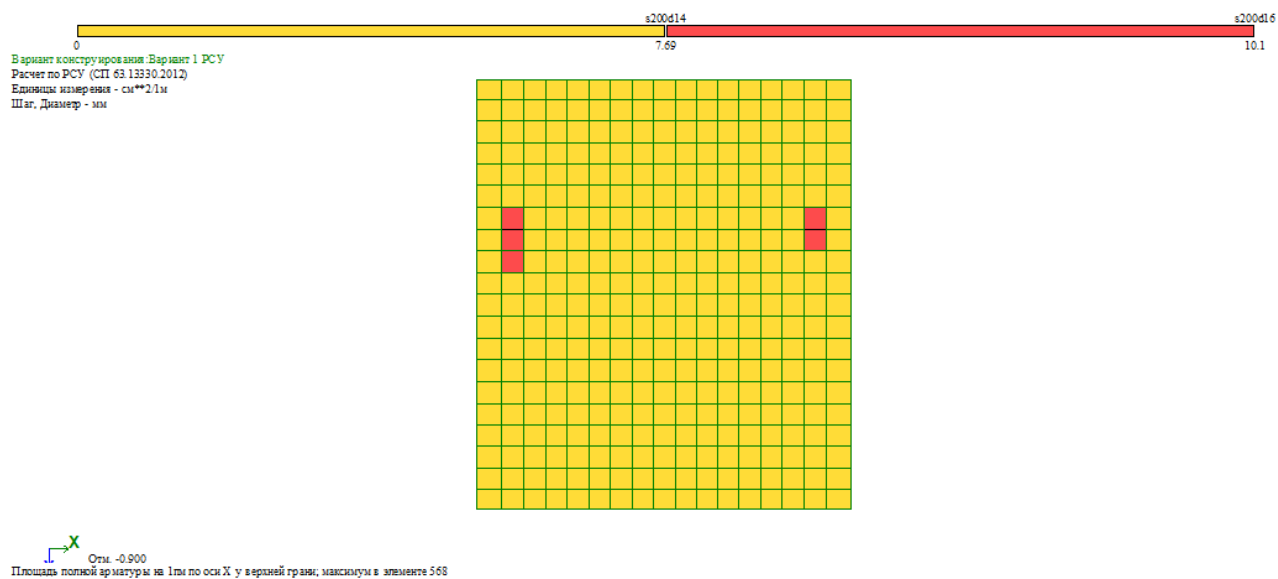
По оси X верхней грани – площадь полной арматуры 1 п.м.
